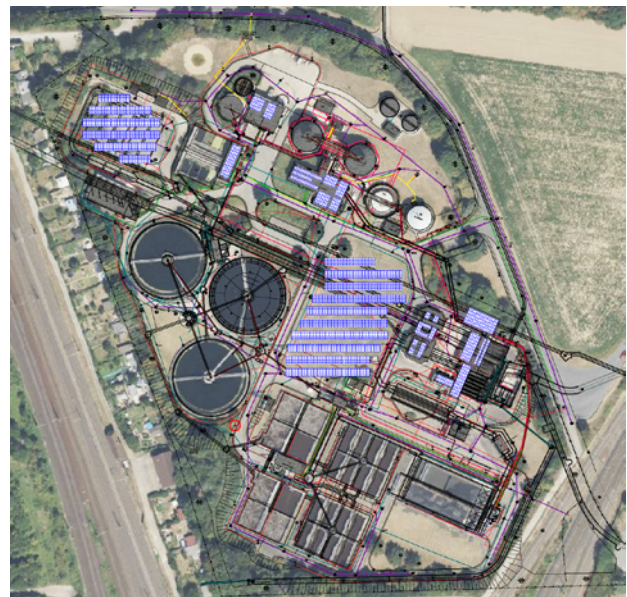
Lageplan AKW Wahn / © StEB Köln
